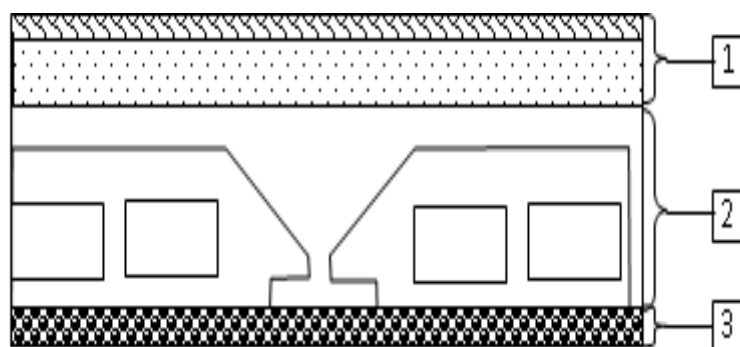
Section transversale d'un plancher à corps creux d'étage courant
